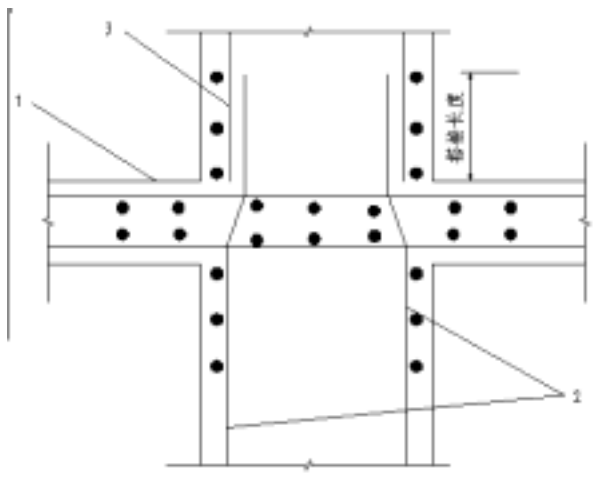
1 钢筋焊接网的竖向搭接图
